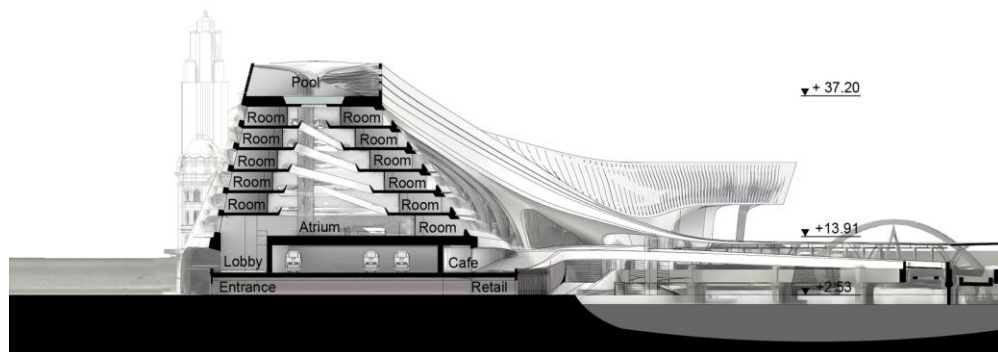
23 Potongan Melintang Bangunan Stasiun Baru
